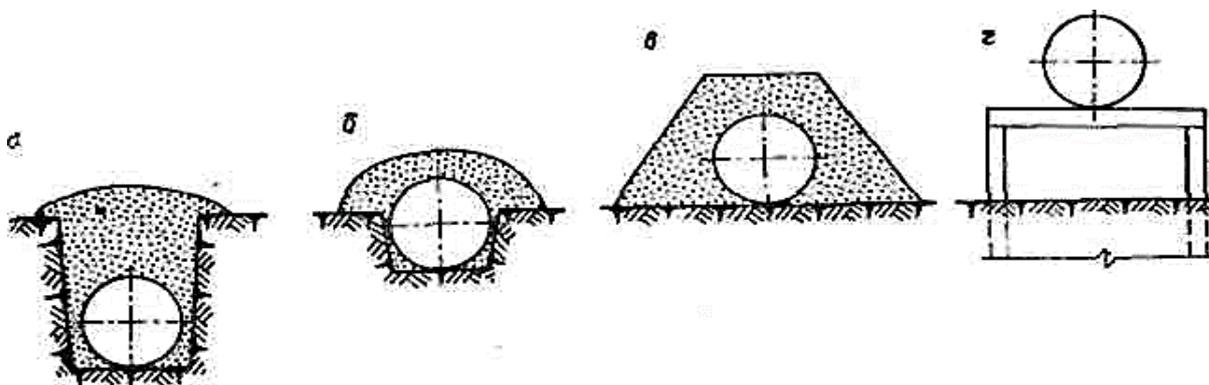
Конструктивные схемы укладки трубопроводов
